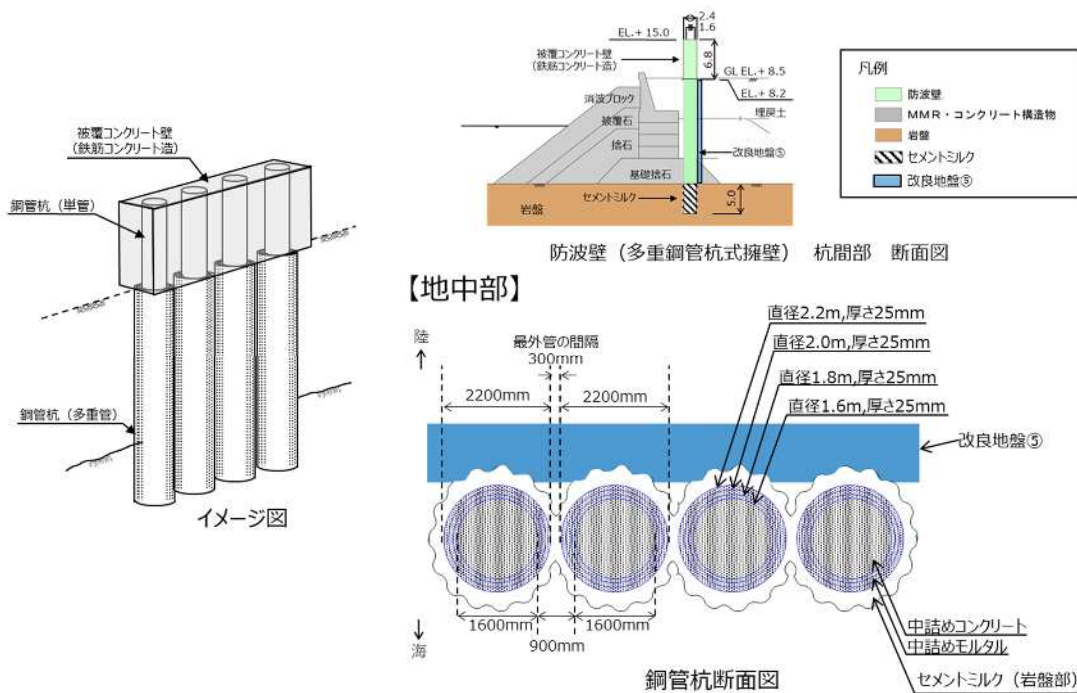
防波壁 (多重鋼管杭式擁壁) の構造概要図 (断面図)
